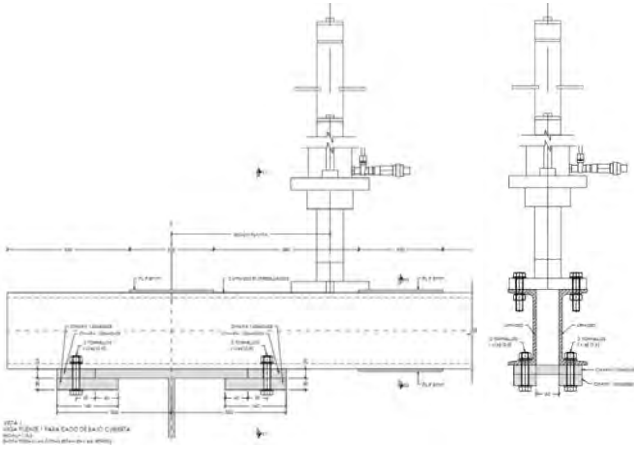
Plano de viga puente 1 y disposición del gato de izado.
